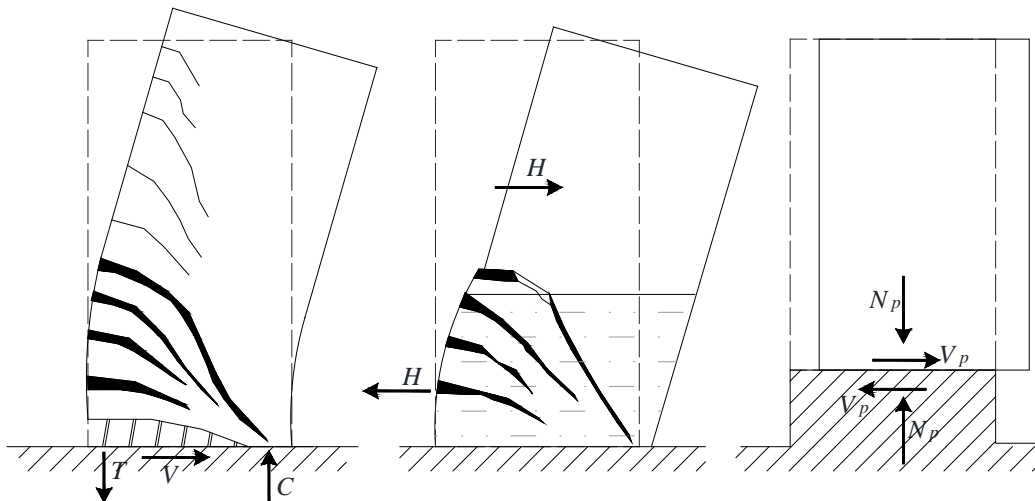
Muros estructurales en voladizo (Paulay and Priestley, 1992)²³
